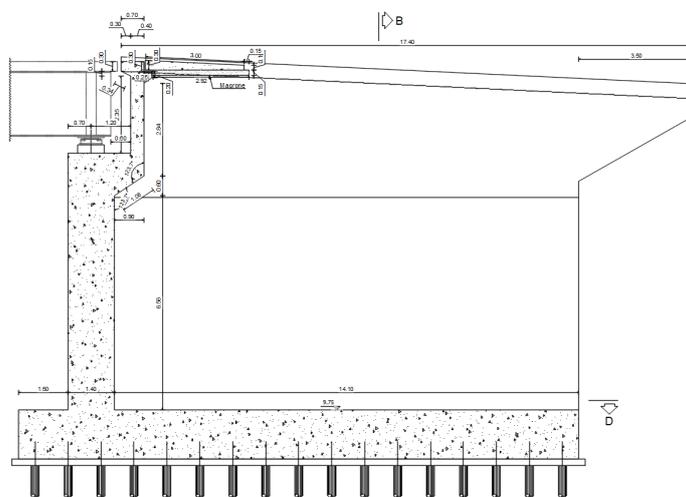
Sezione spalla "SP2" lato Rotatoria 2
